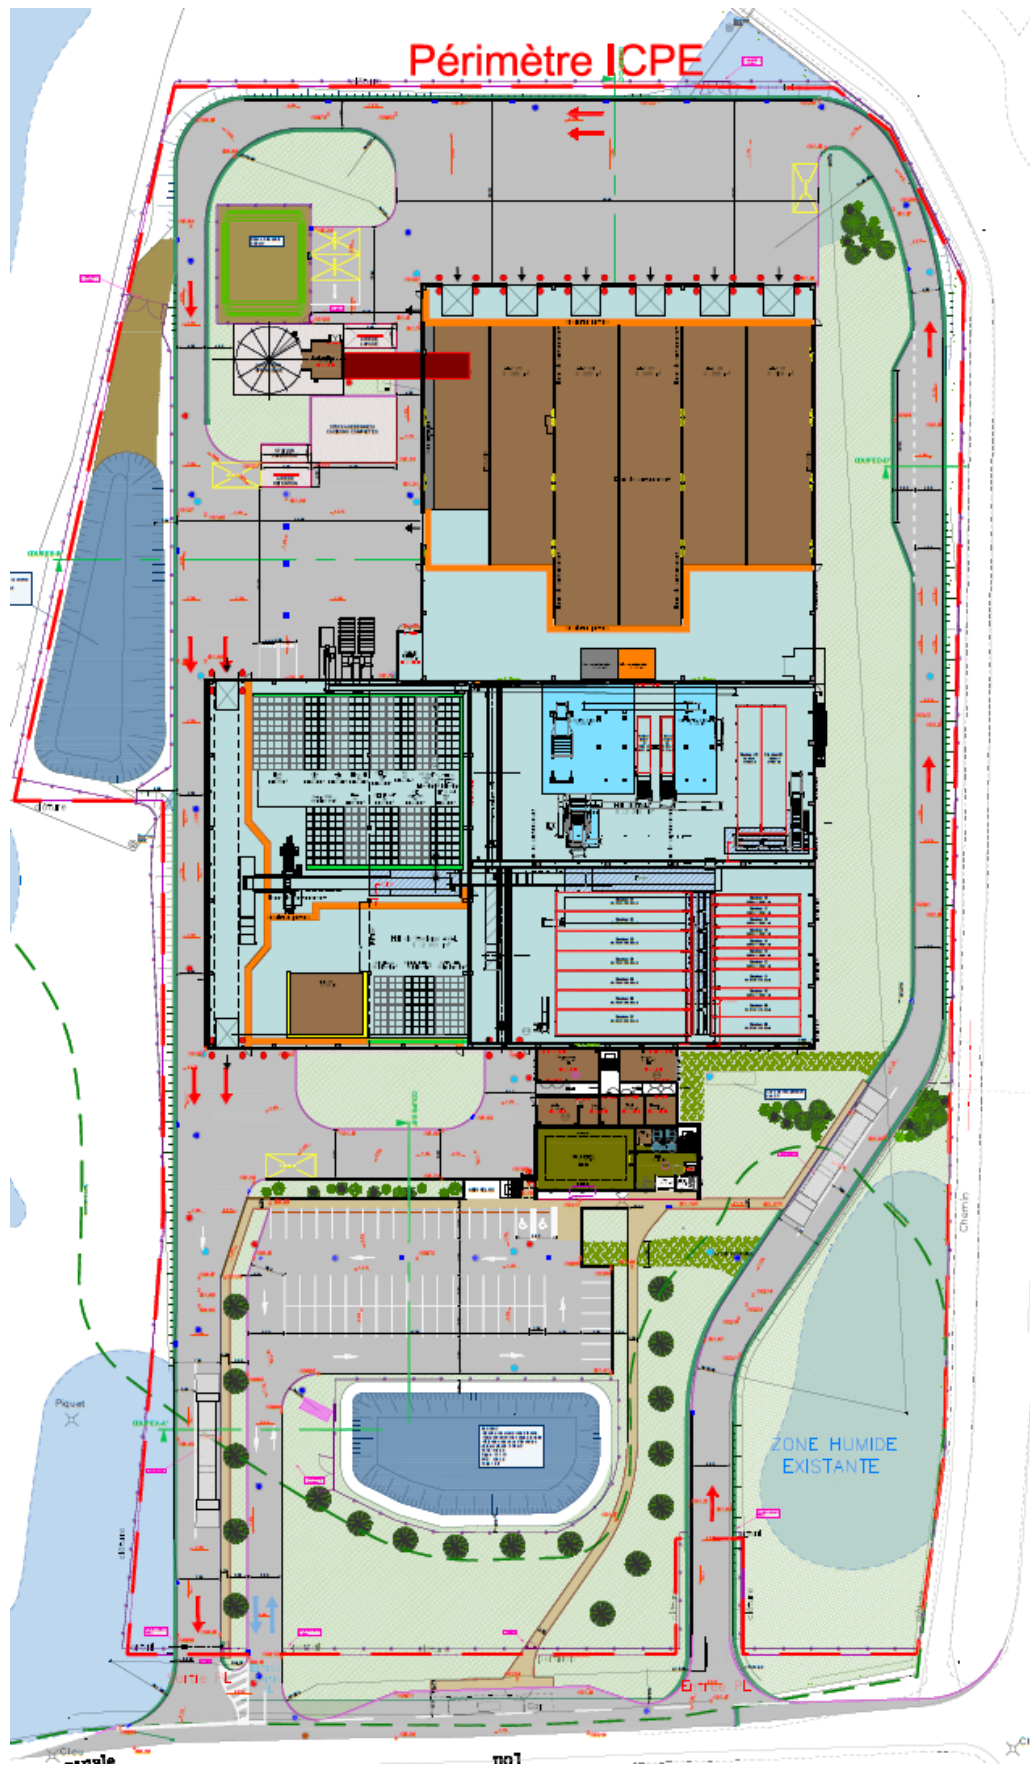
Plan de zonage et organisation du site (source : groupement Trinovia)
